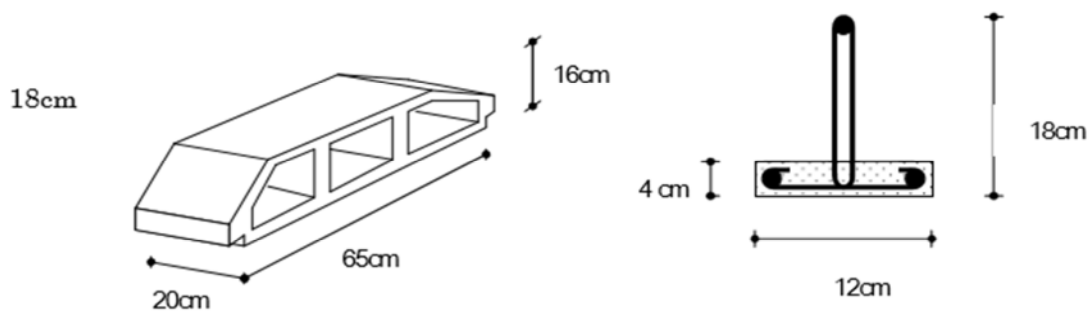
Schéma d'un corps creux Figure III.2.2: Coupe verticale de la poutrelle
